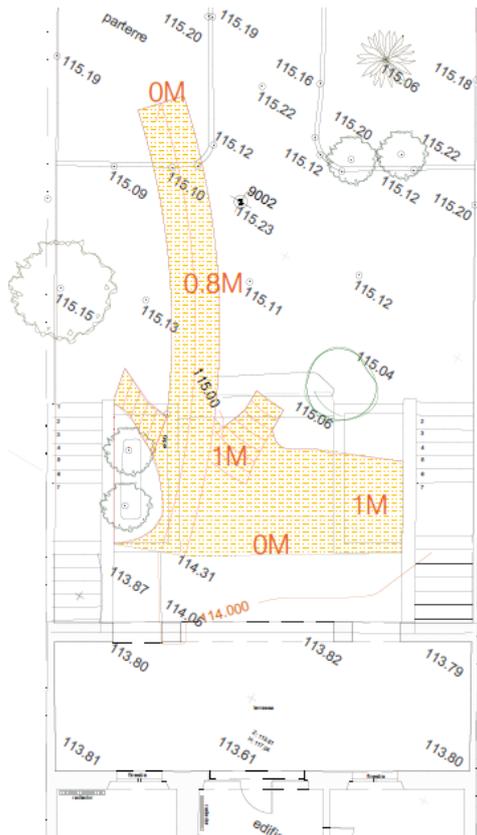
Detalles de la estructura bajo la terraza del jardín interior del inmueble
